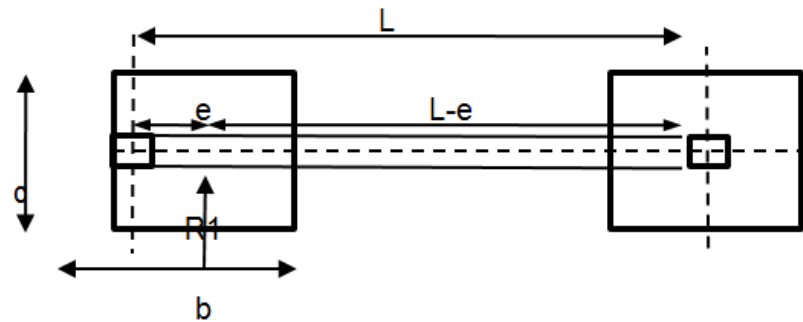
Diseño de zapata de lindero. Fuente:
